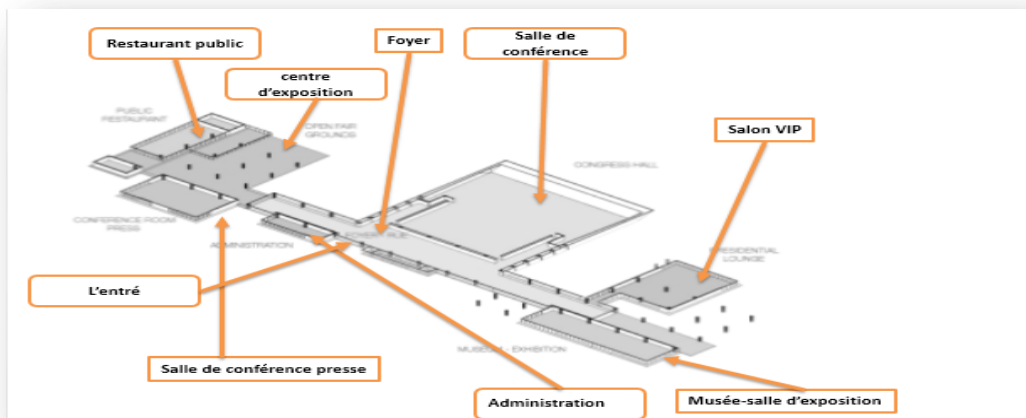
Le plan de R.D.C du centre de conférences.
